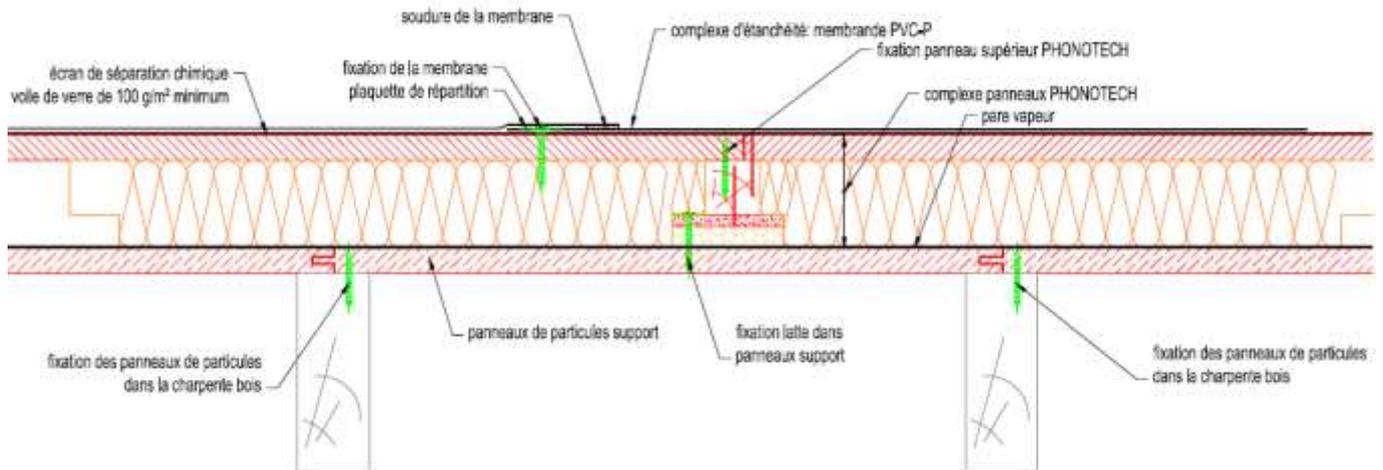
Coupe verticale sur assemblage des éléments PHONOTECH DK
